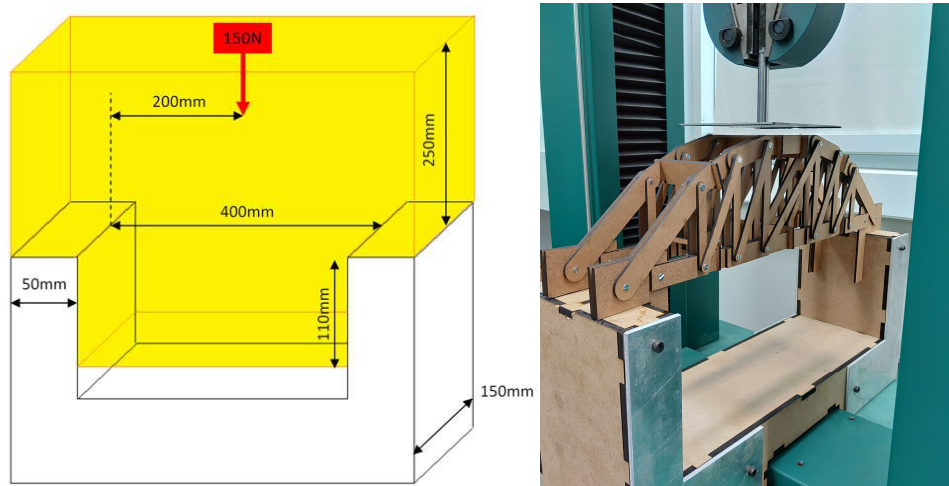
Modelo do suporte para ensaio e restrições de geometria da ponte.
